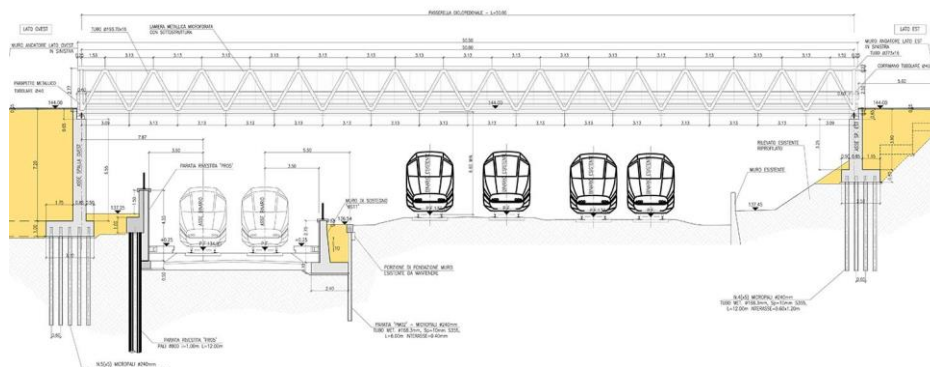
Sezione longitudinale passerella ciclopedonale via Lopez.
